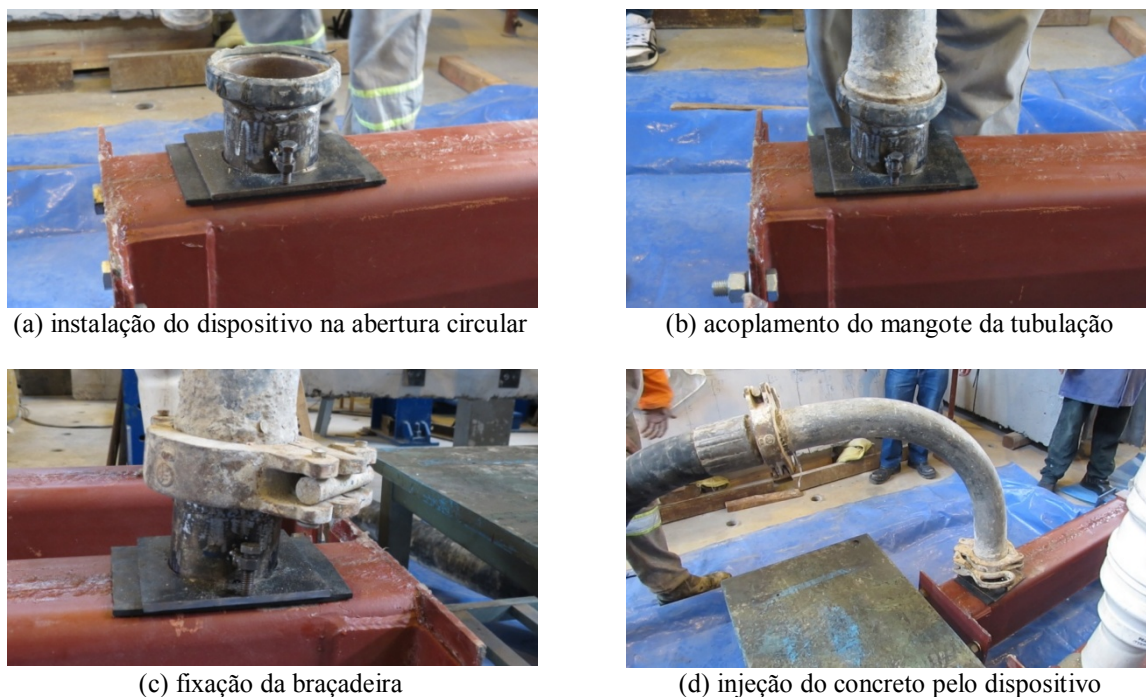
Ensaios de concretagem: dispositivo metálico para concretagem com pressão
